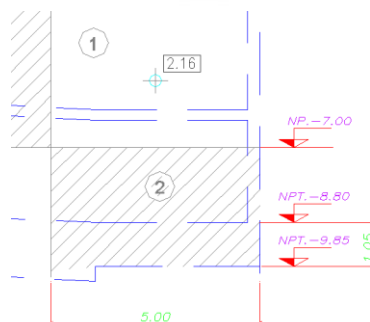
Muros Anclados – Nivel de Cimentación.
